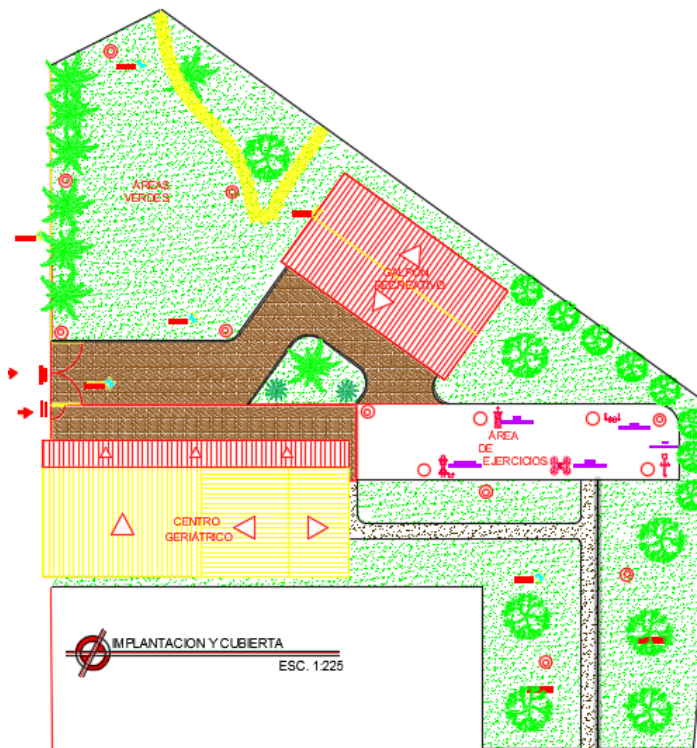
Vista en planta actual del terreno de implantación del proyecto
